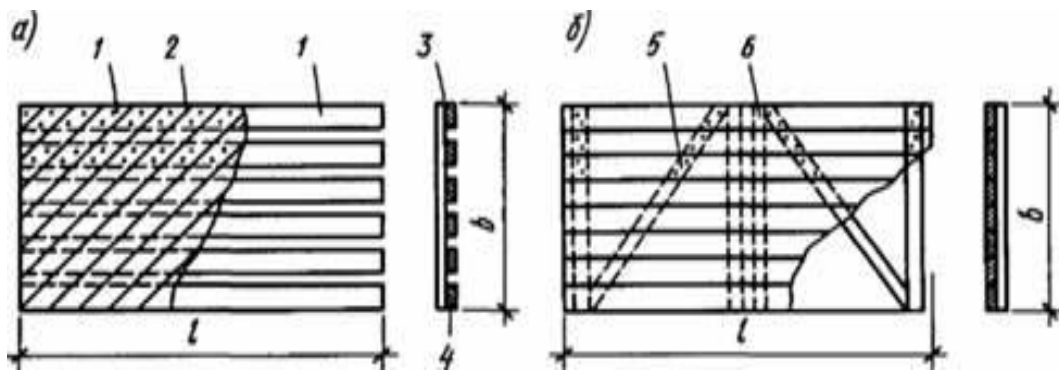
Дощато-цвяхові щити настилів покриттів: а – щит подвійного перехресного настилу; б – щит одношарового разкісного настилу; 1-дощки; 2-цвяхи; 3-косий захисний настил; 4-розріджений робочий настил; 5 – розкоси; 6– поперечки
